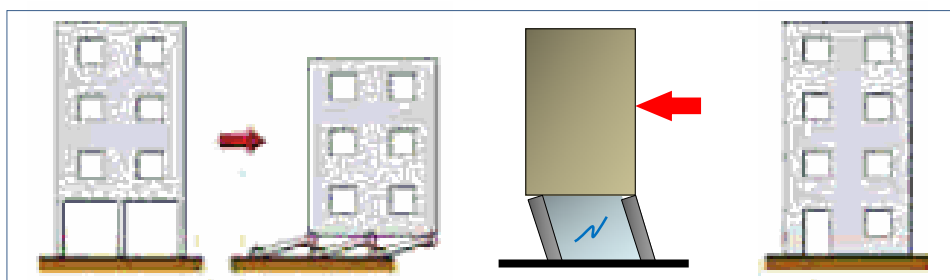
Formation d'un étage souple au rez-de-chaussée
